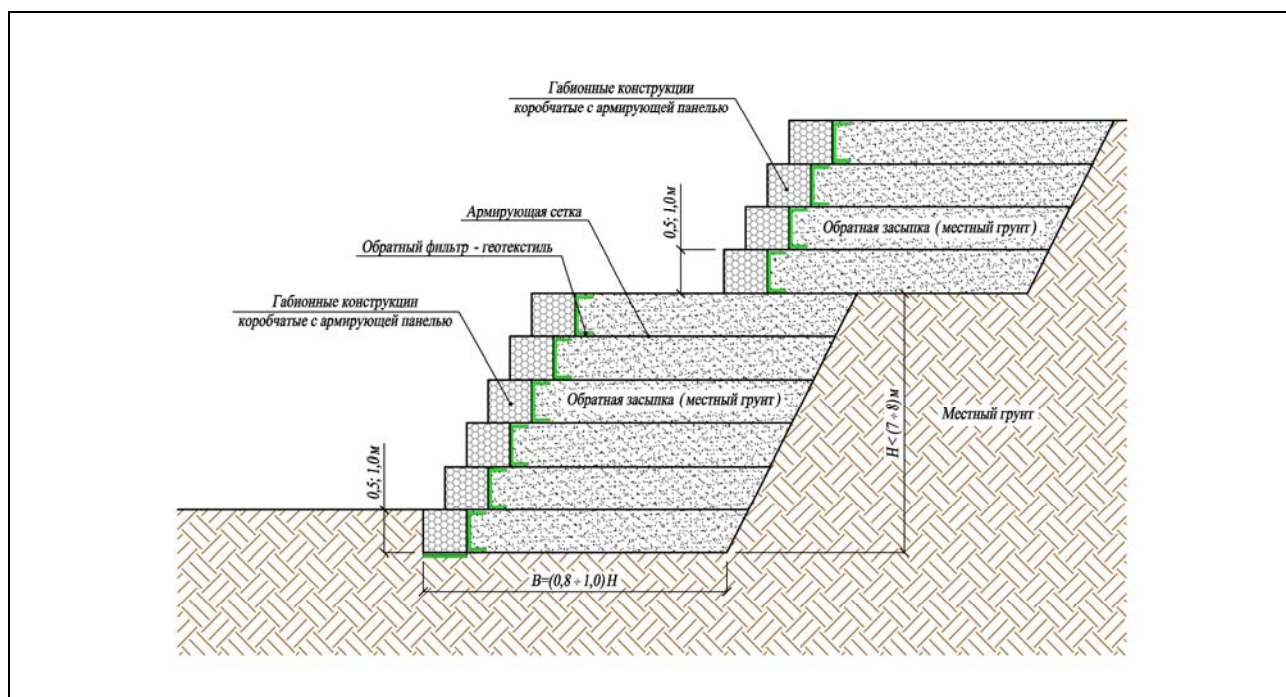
Схема комплекса подпорно-удерживающих сооружений из коробчатых габрионных конструкций с армирующей панелью
